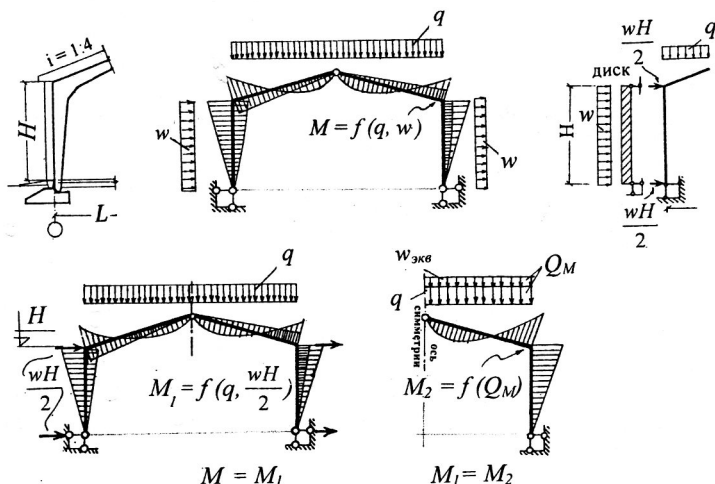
Приведение силового воздействия ветровой нагрузки к эквивалентной от суммарной модульной нагрузки на покрытие
